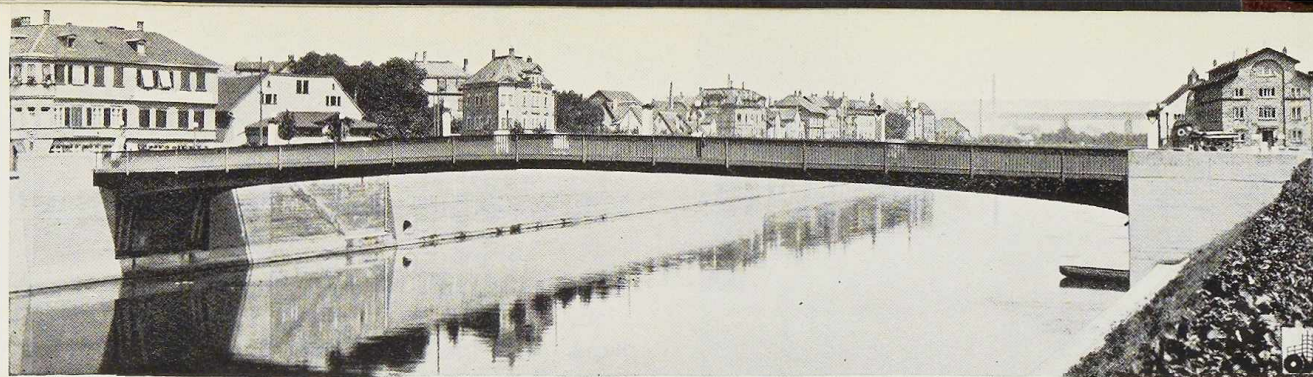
Pont Wilhelm sur le Neckar à Cannstadt – Pont à béquilles de 70 m.
